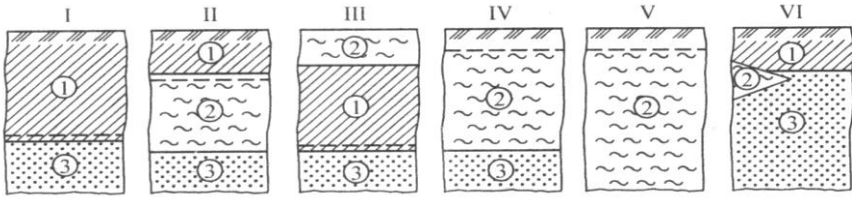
Схеми типових напластувань ґрунтів (I - VI): 1 - придатні; 2 - слабкі; 3 – щільні.
